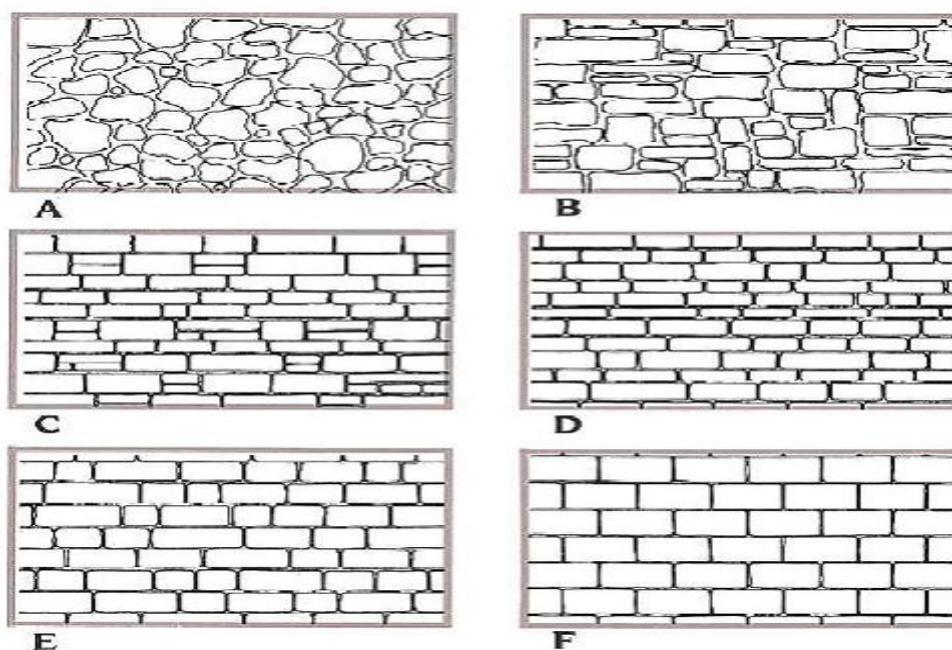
Principaux appareils de la maçonnerie en pierre. « La maçonnerie de la pierre » [13]
